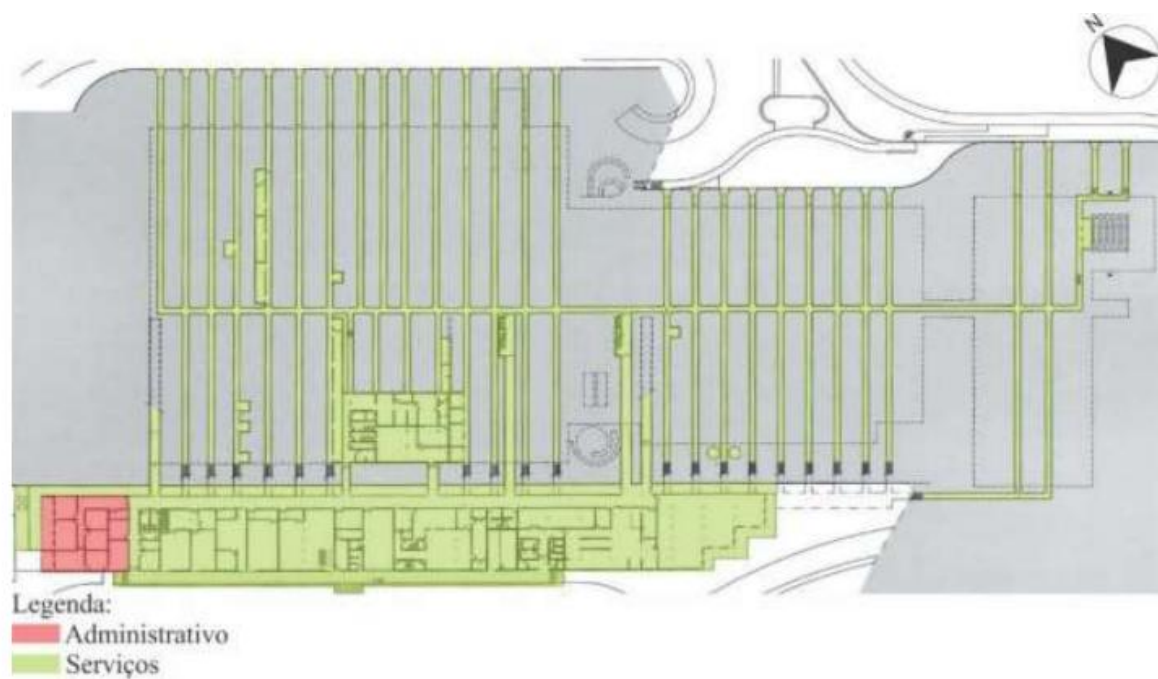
Planta de setorização hospitalar do pavimento térreo
